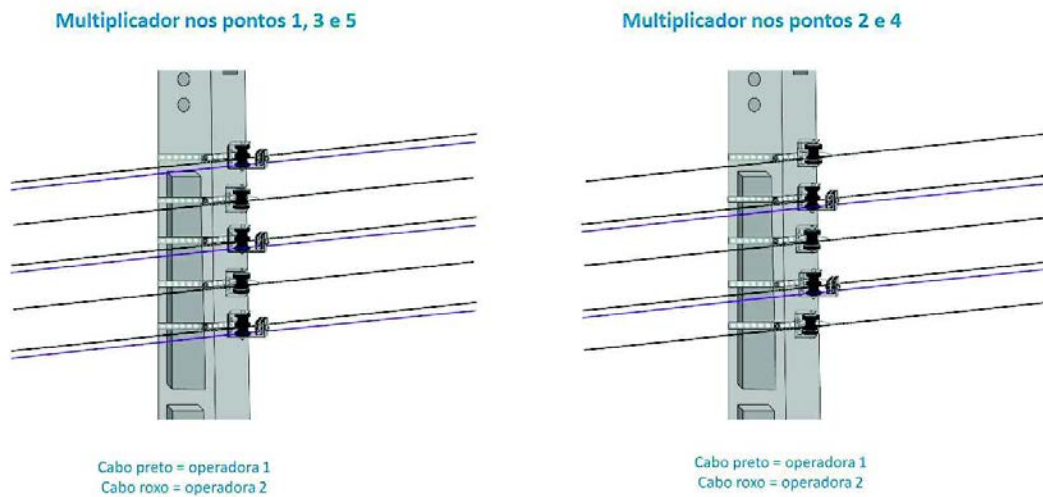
Suporte Multiplicador de Pontos aplicação.
